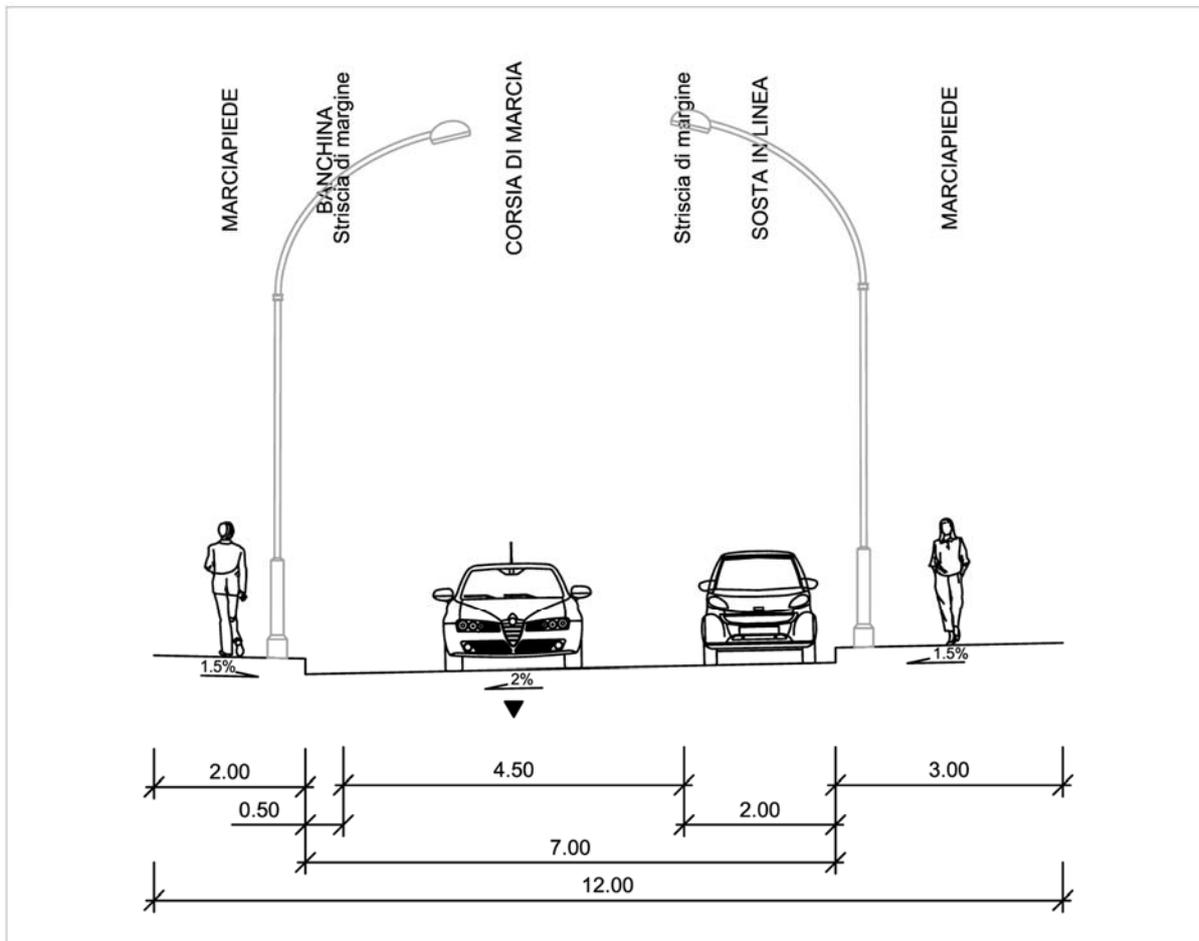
NUOVO COLLEGAMENTO: STATO DI FATTO E SEZIONE TIPO PROPOSTA
